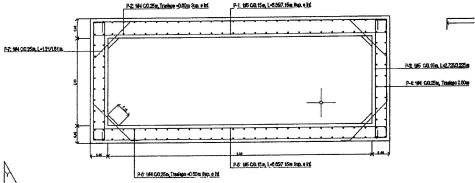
Vista en perfil del puente a construir sobre la Acequia Las Mercedes. Fuente: Planos entregados por el Solicitante.
